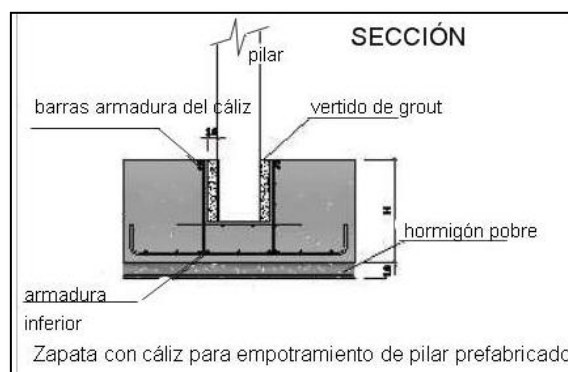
Sección de zapata con cáliz para empotramiento de pilar
